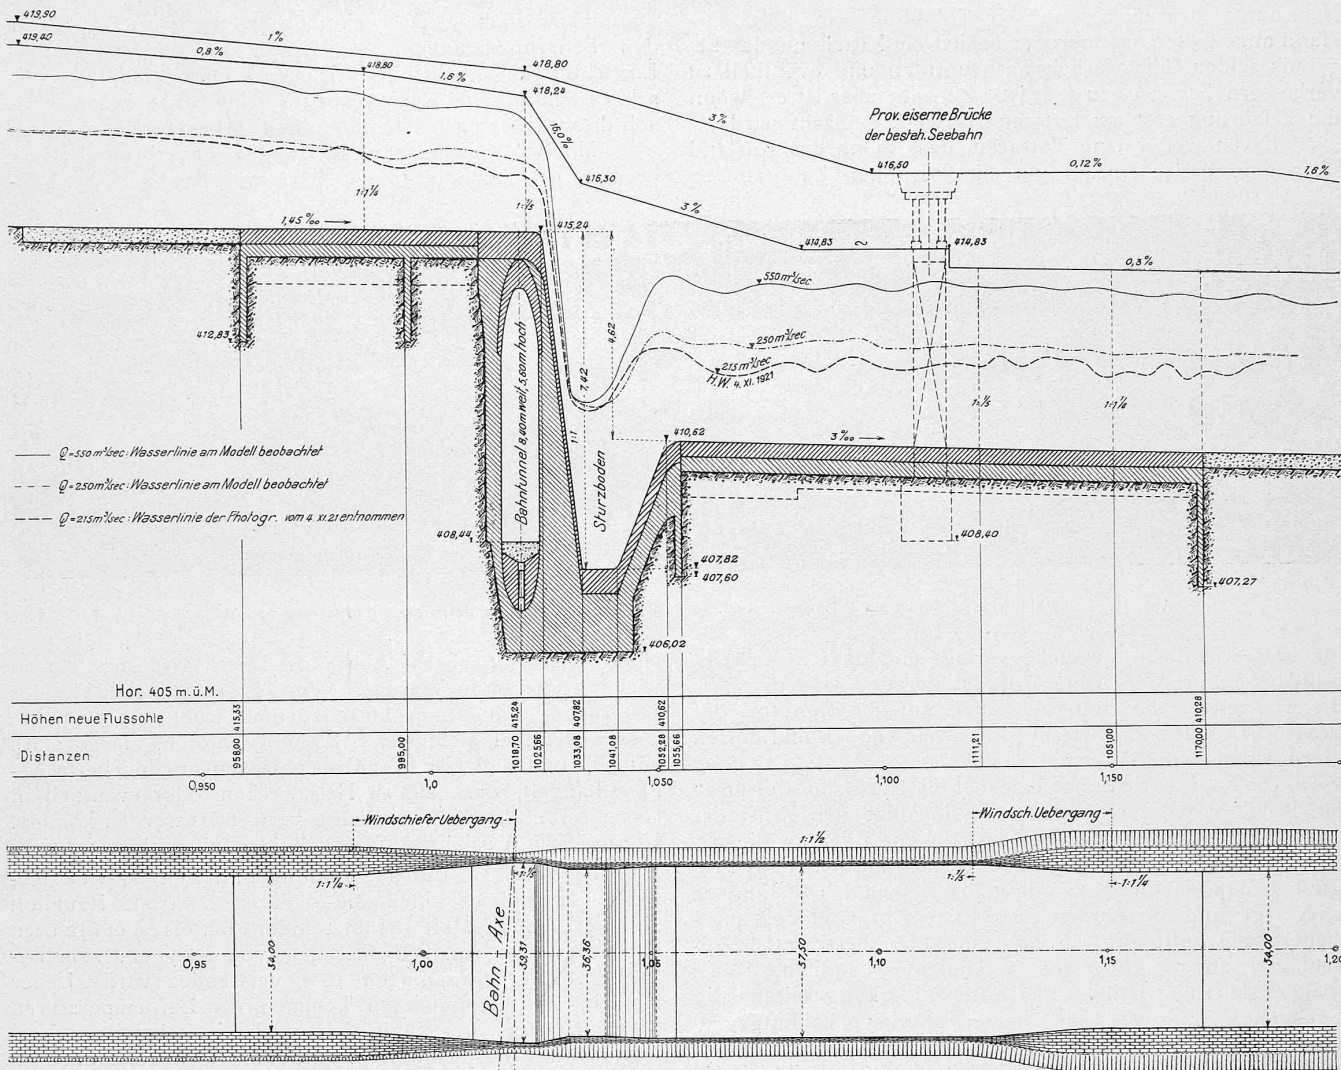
und 9. Grundriss und Längsschnitt des Sihlüberfalls mit eingetragenen Wasserlinien. — Masstab der Längen 1 : 1500, der Höhen 1 : 150.
